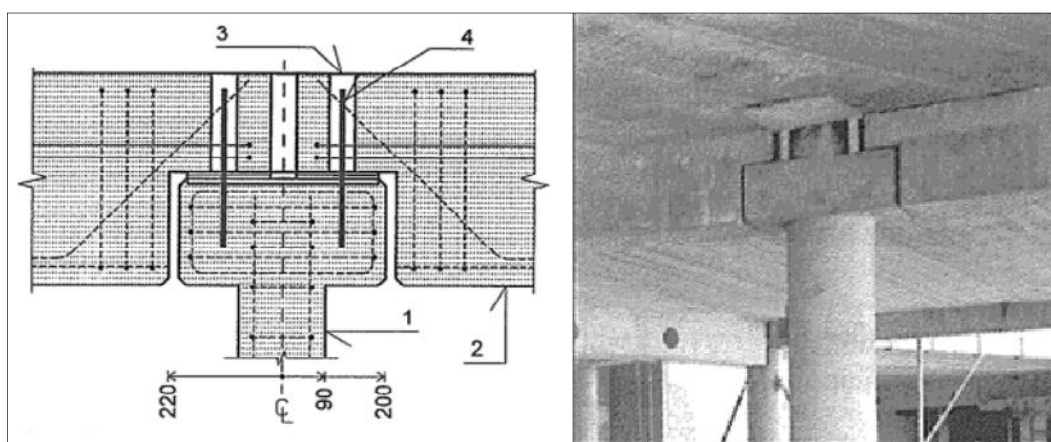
Ligação viga-pilar concebida com recurso a vigas com extremidade indentada (adaptado de Sai e Kjæbye, 1999);
